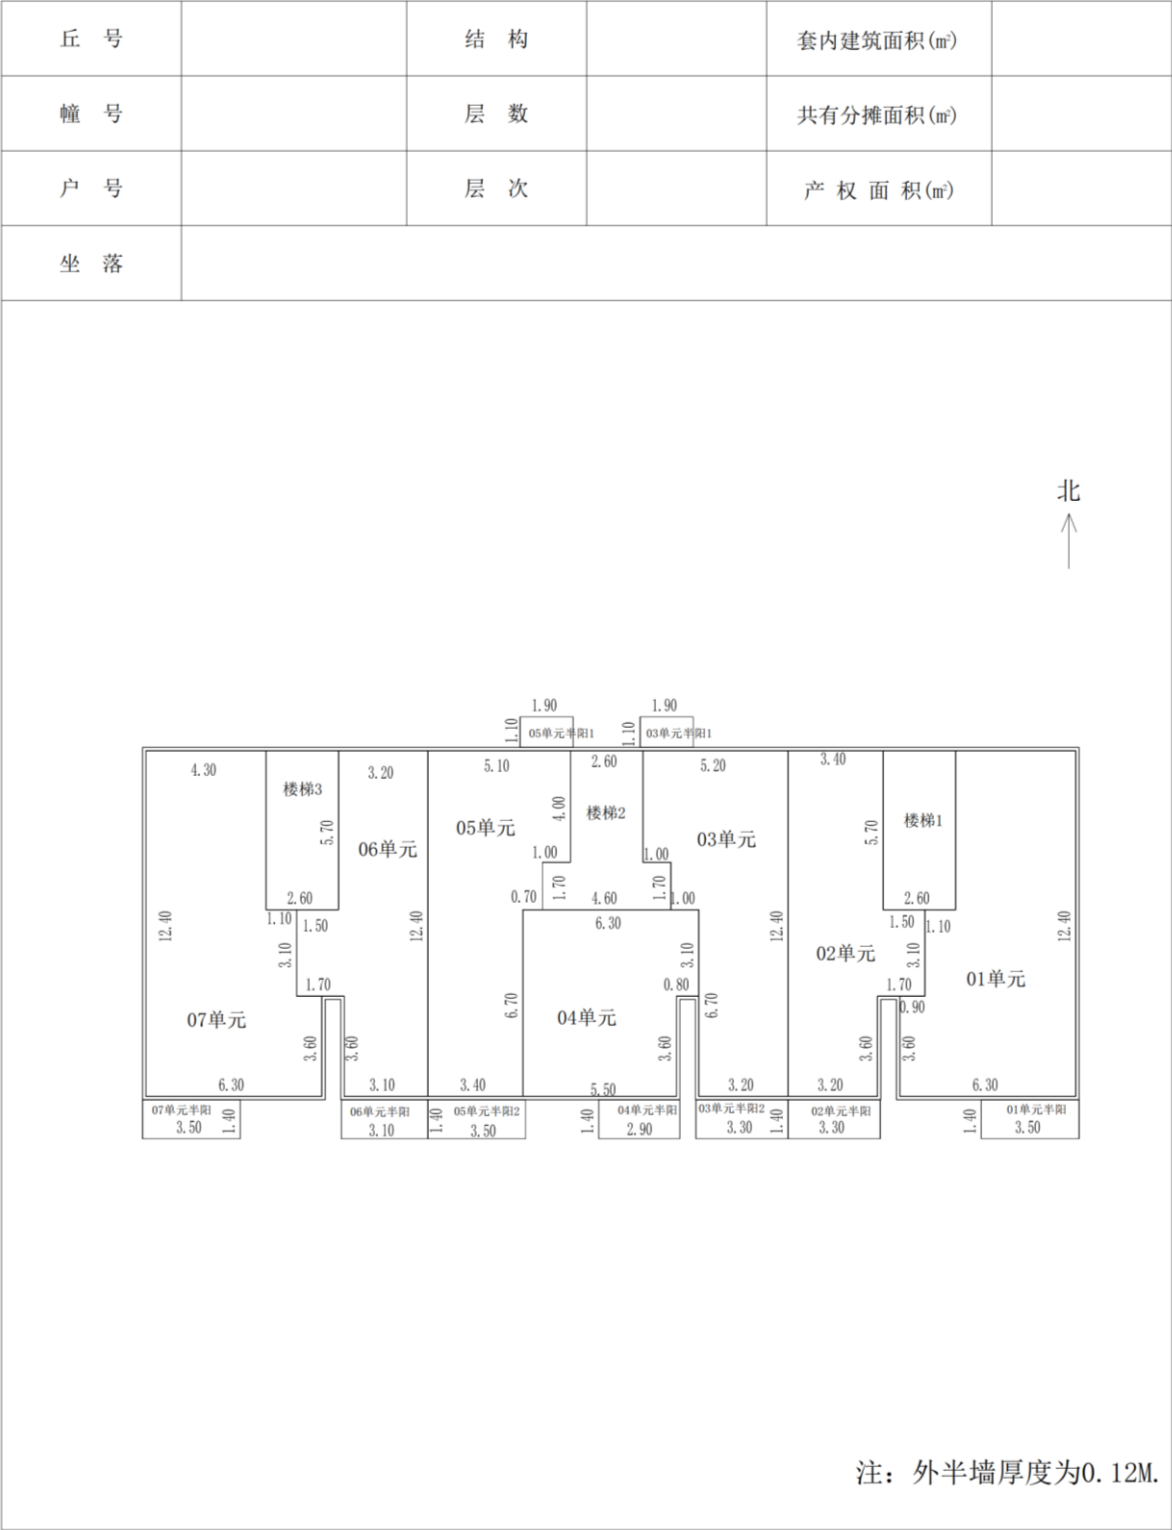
房屋分层分户平面图样示 1 局部放大图
